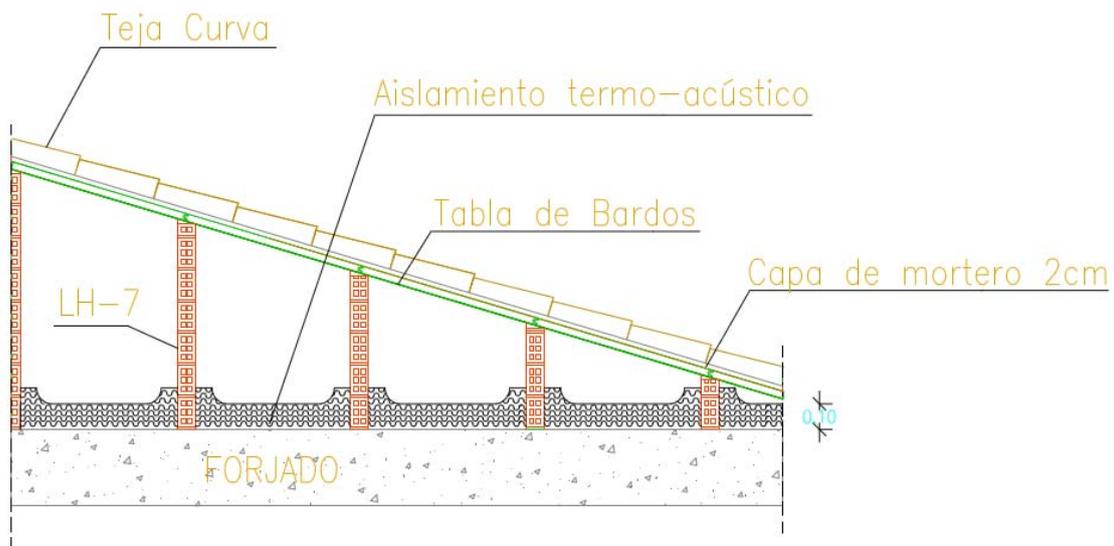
Detalle constructivo de la cubierta con tabicón con la solución propuesta.
